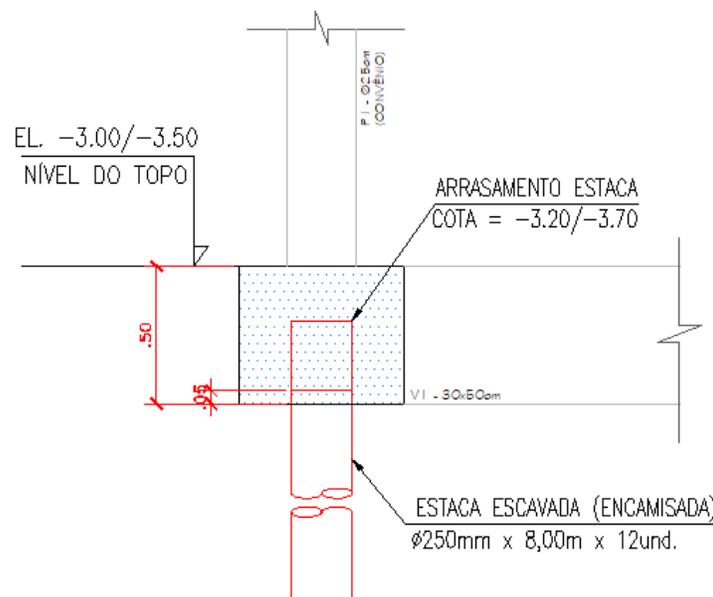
Detalhe do Bloco de Coroamento e Viga.
